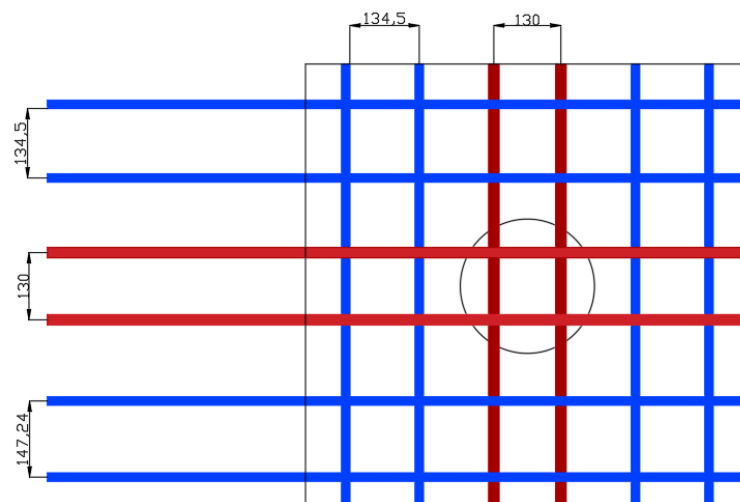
Armadura Pila 2 lado largo, Transversal y longitudinal, Espaciado entre las diferentes barras
